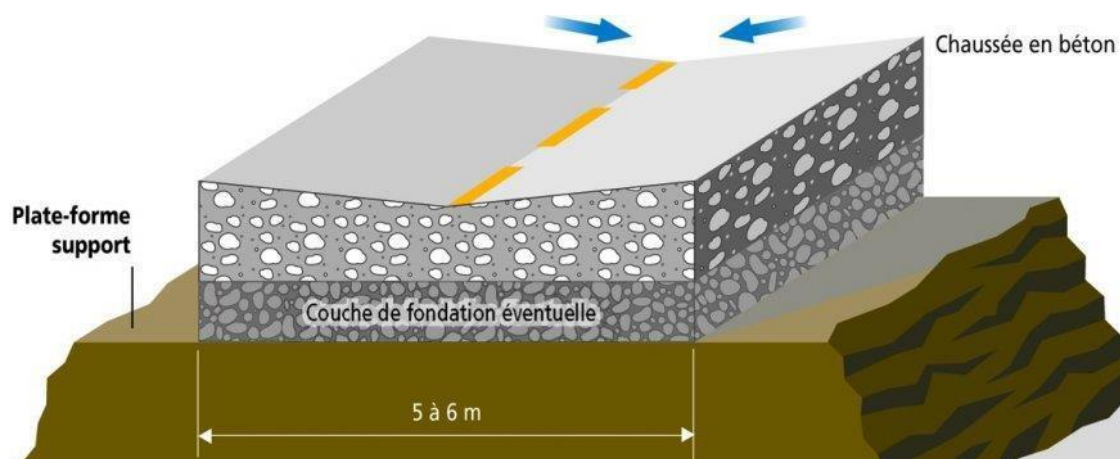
les différentes couches d'une chaussée en béton drainant [13].
